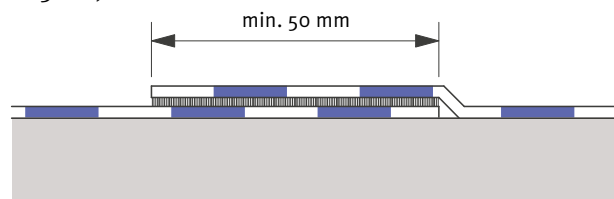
Joint de recouvrement avec matériau de collage et d'étanchéité.
